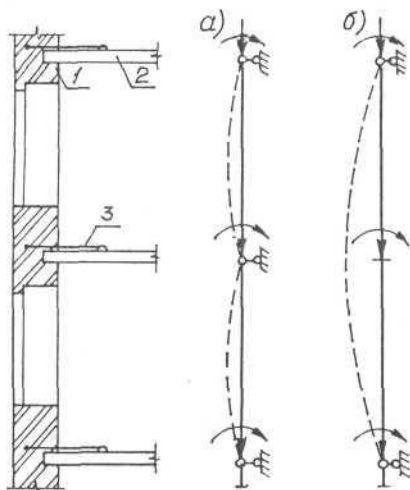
(1 — стена, 2 — плиты перекрытий, 3 — анкера)
